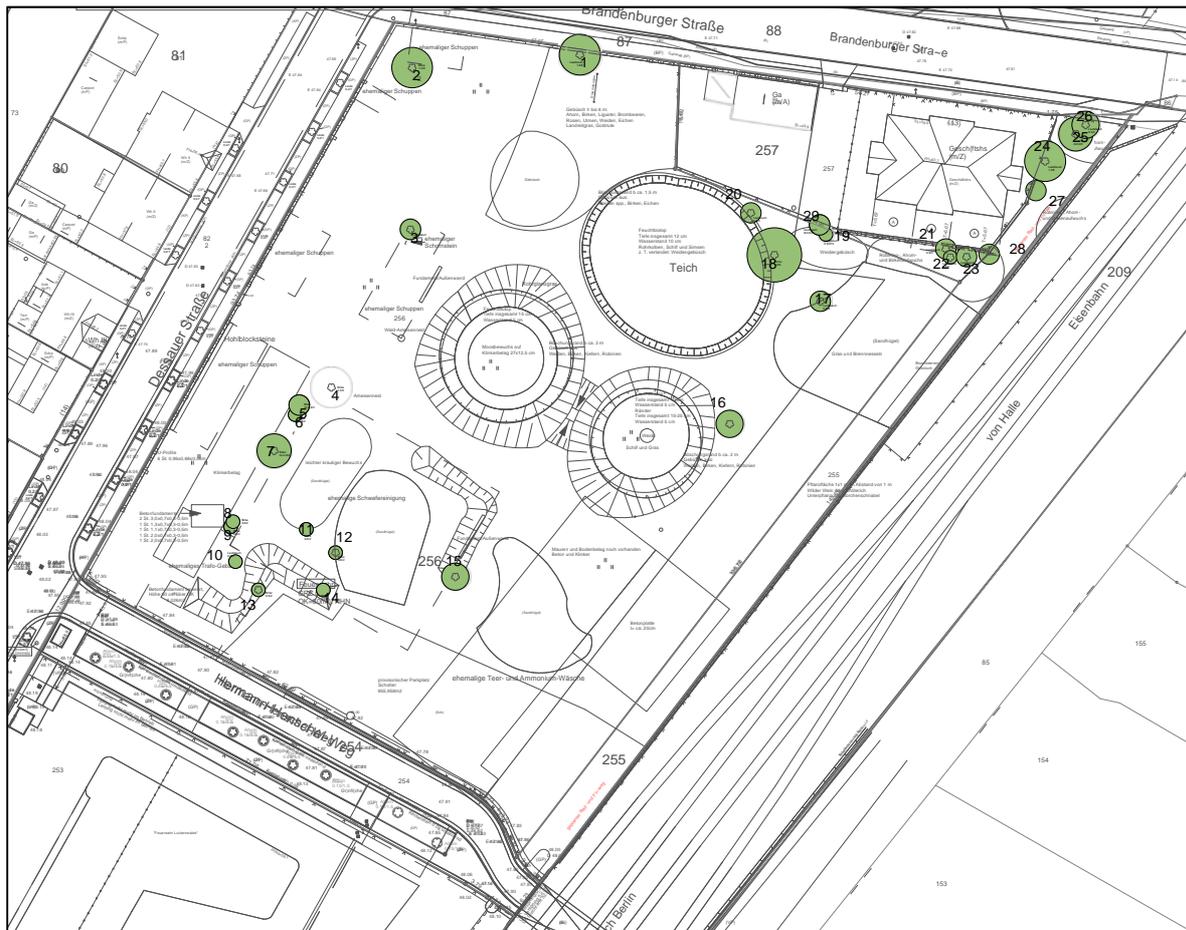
Baumbestand (ohne Straßenbäume) im Plangebiet<sup>1</sup>
